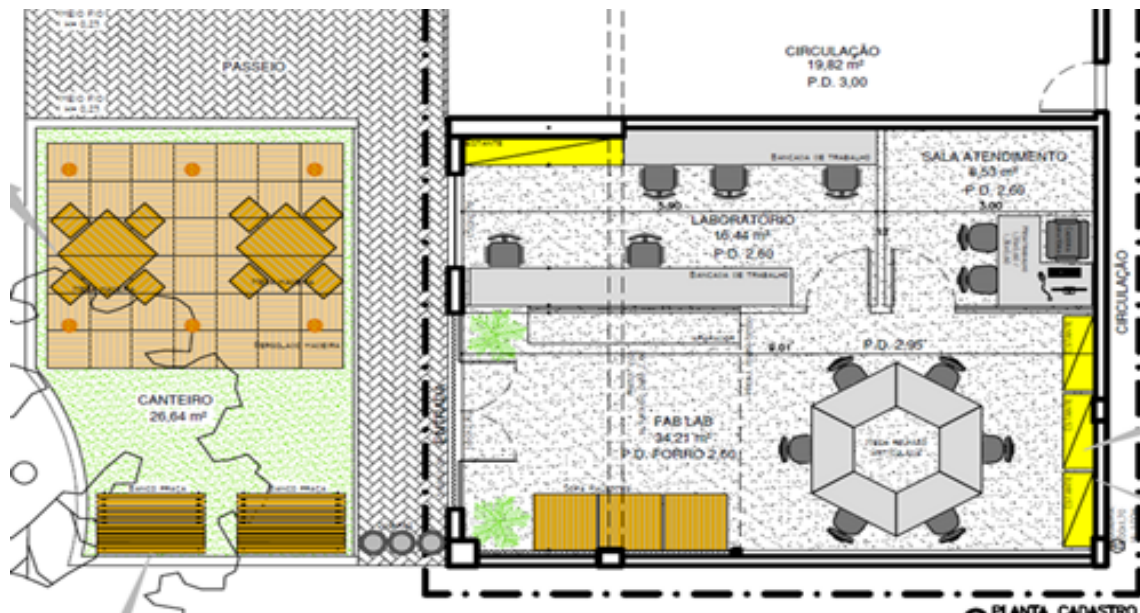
Planta do Espaço de Inovação Mandacaru Lab. Fonte: o autor
